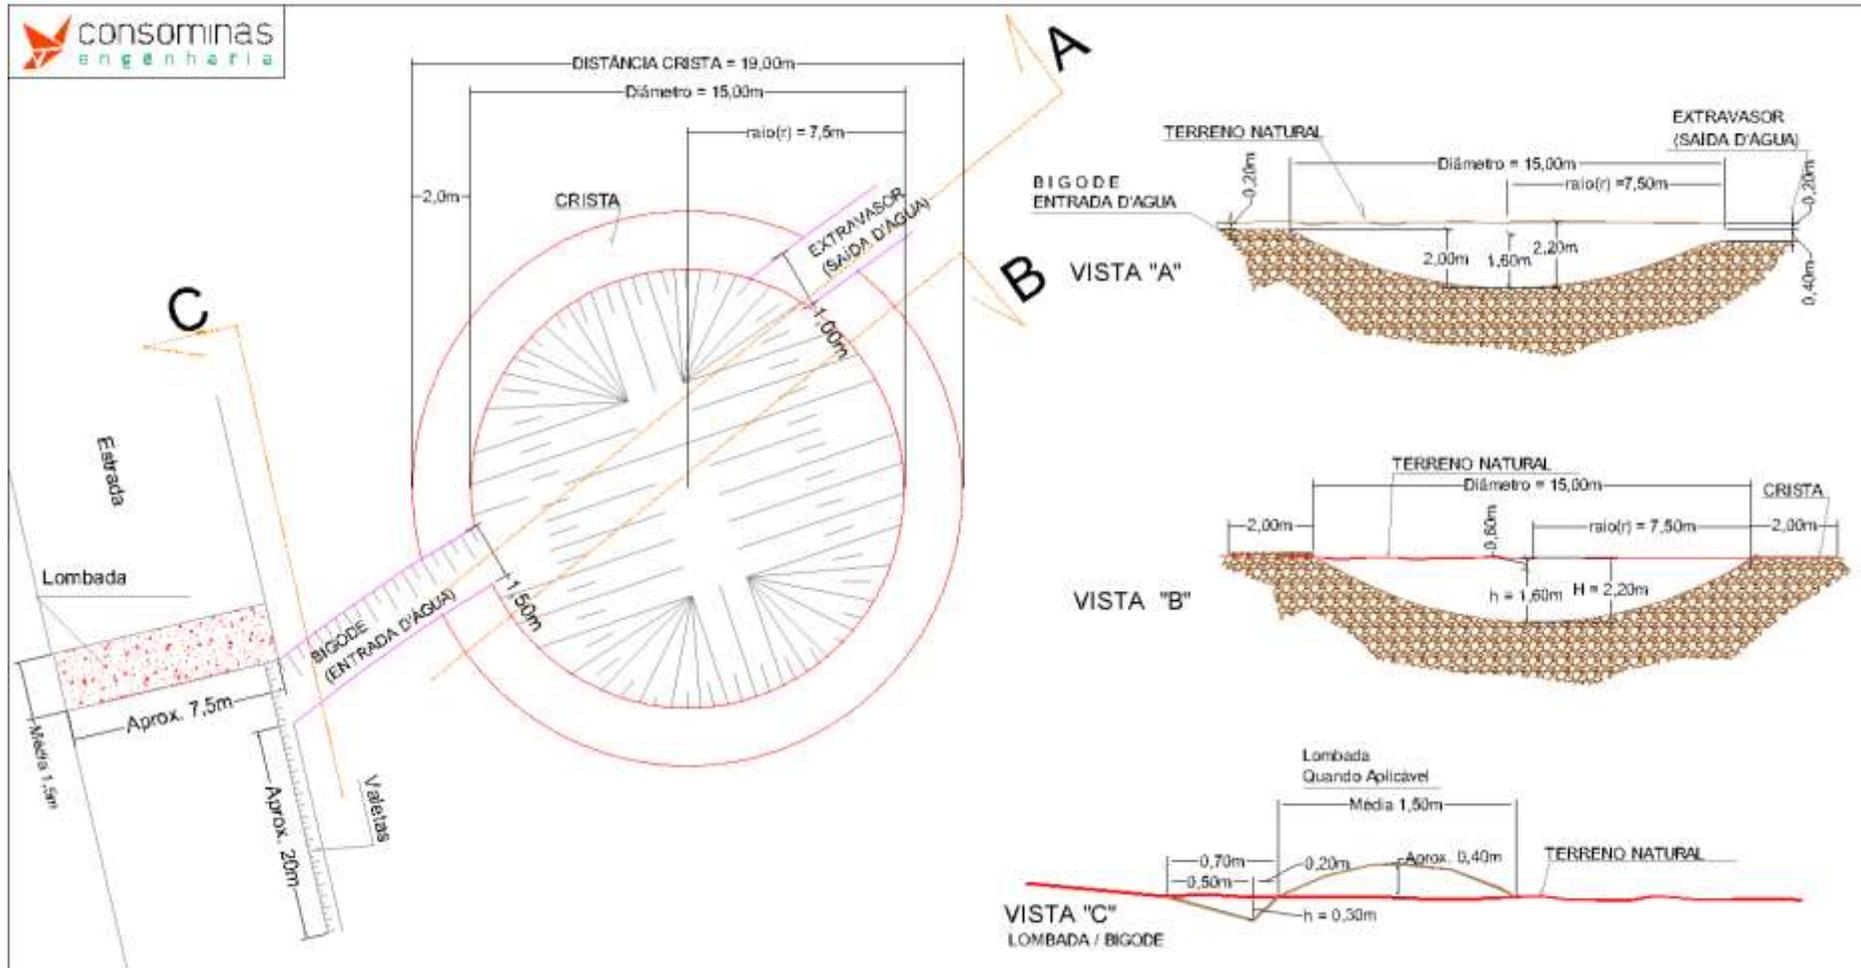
Planta e perfil de bacia de contenção do Tipo I e suas estruturas acessórias.
